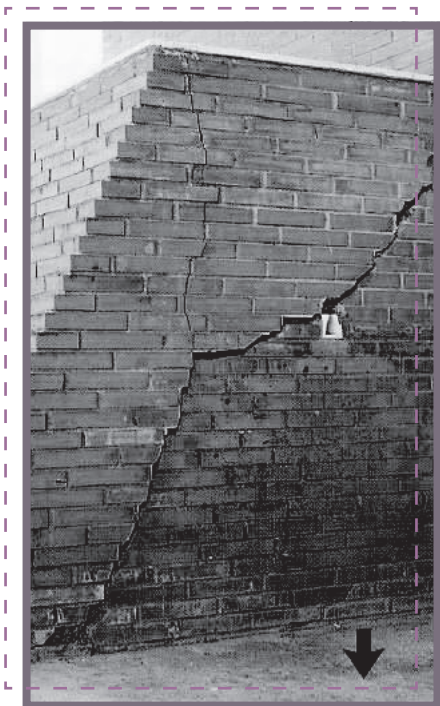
Imagen de las fisuras por asiento debido a la consolidación desigual del terreno.
